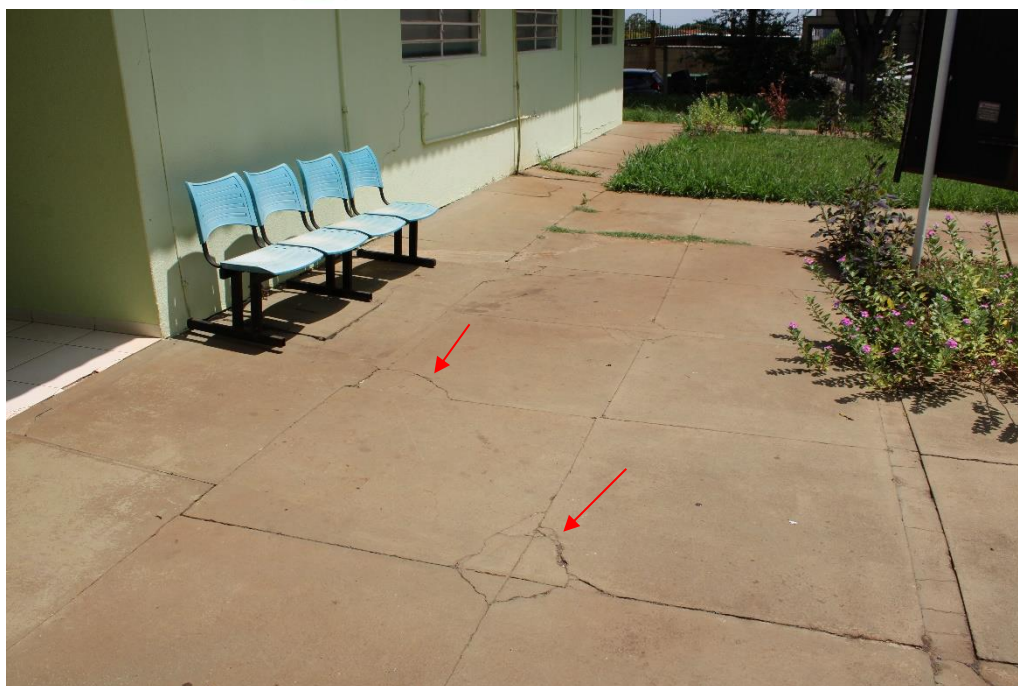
Fissuras em calçamento externo em concreto desempenado.
